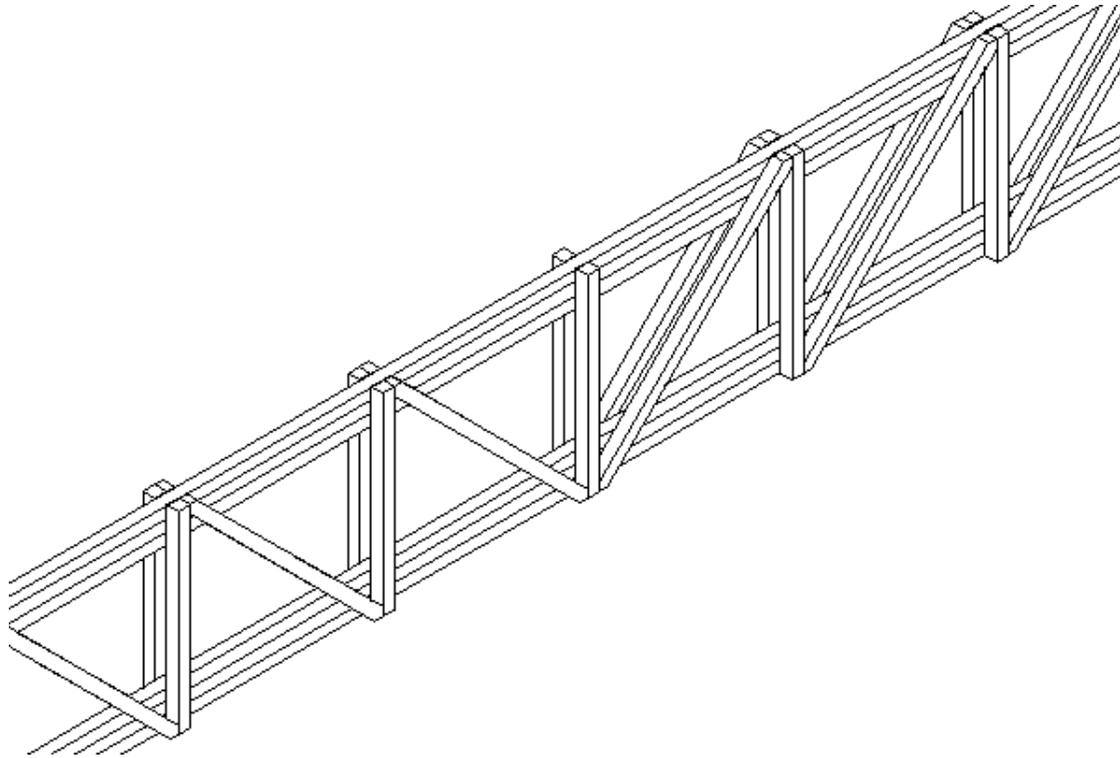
Reticulado plano de cordones paralelos tipo pratt
